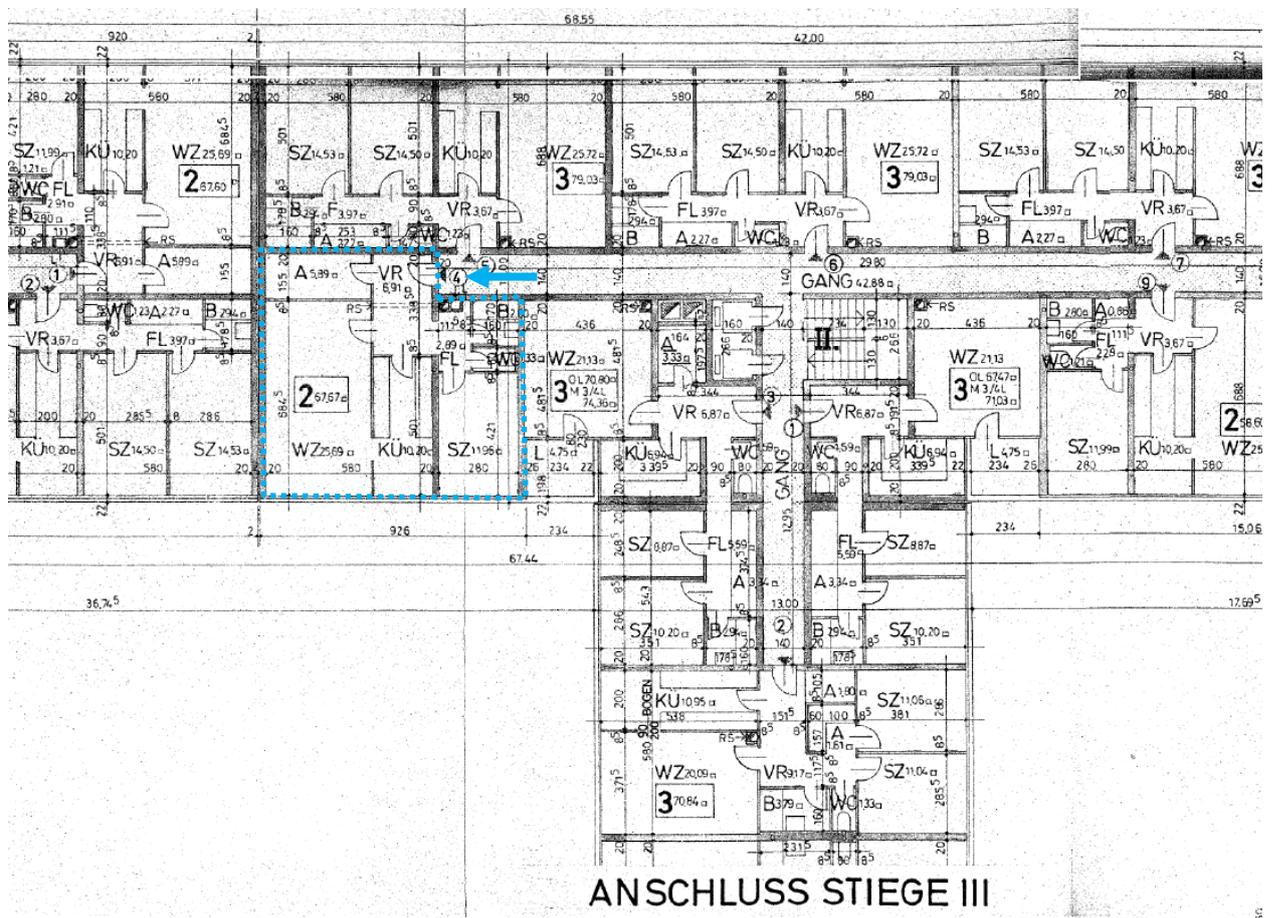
Ausschnitt Grundriss 1. OG, Stiege 2 mit Erg SV; Quelle: Bestandsplan 1971, Bauakt
